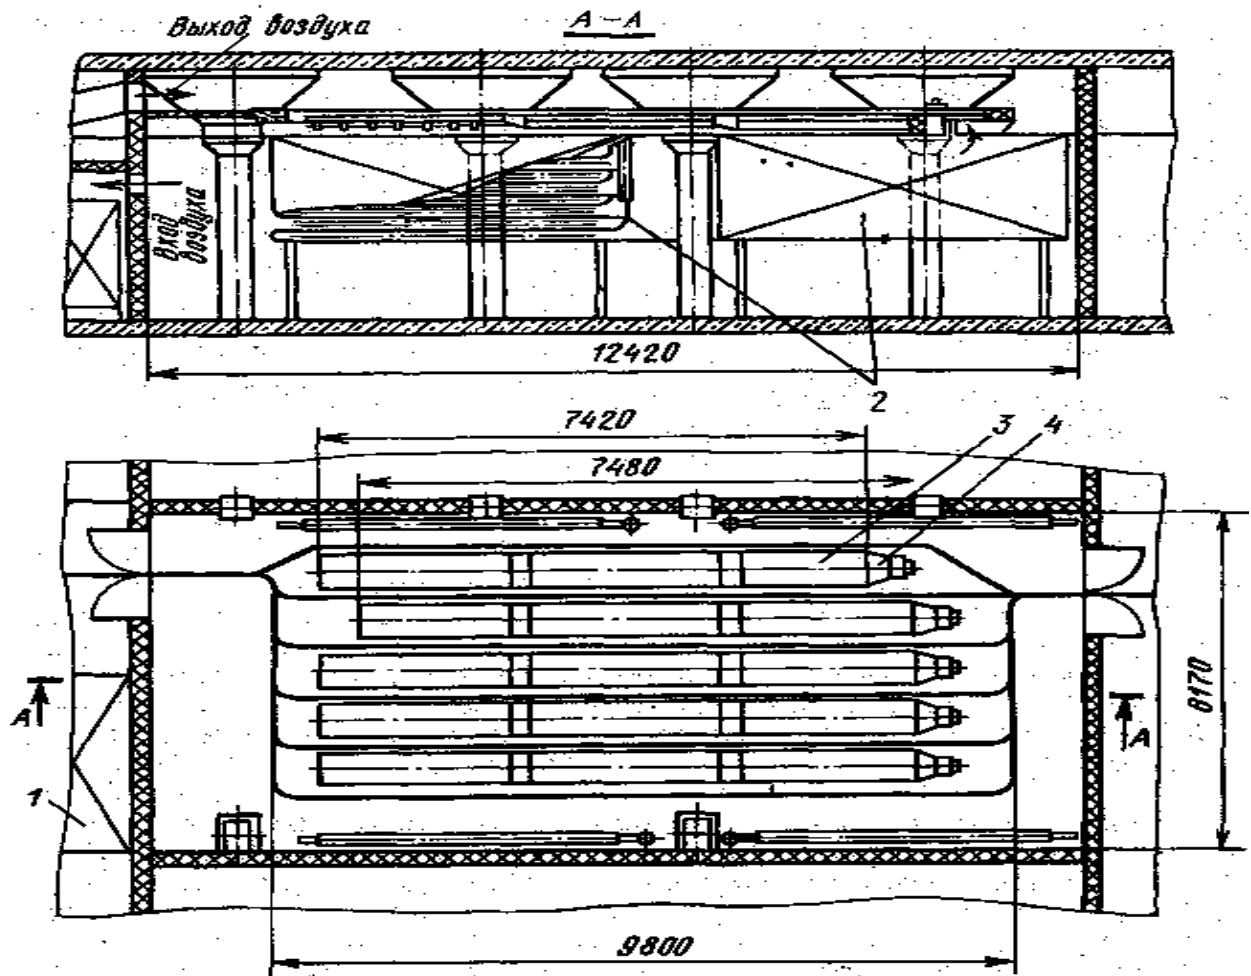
Камера для охлаждения мяса с непосредственным воздушным дотированием: 1 – напольный двухходовой воздухоохладитель; 2 – пристенные батареи; 3 – душирующий канал с соплами; 4 – осевой вентилятор
